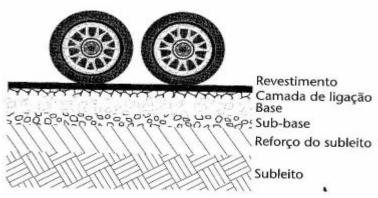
Estruturas de pavimentos Fonte: Balbo (2007
